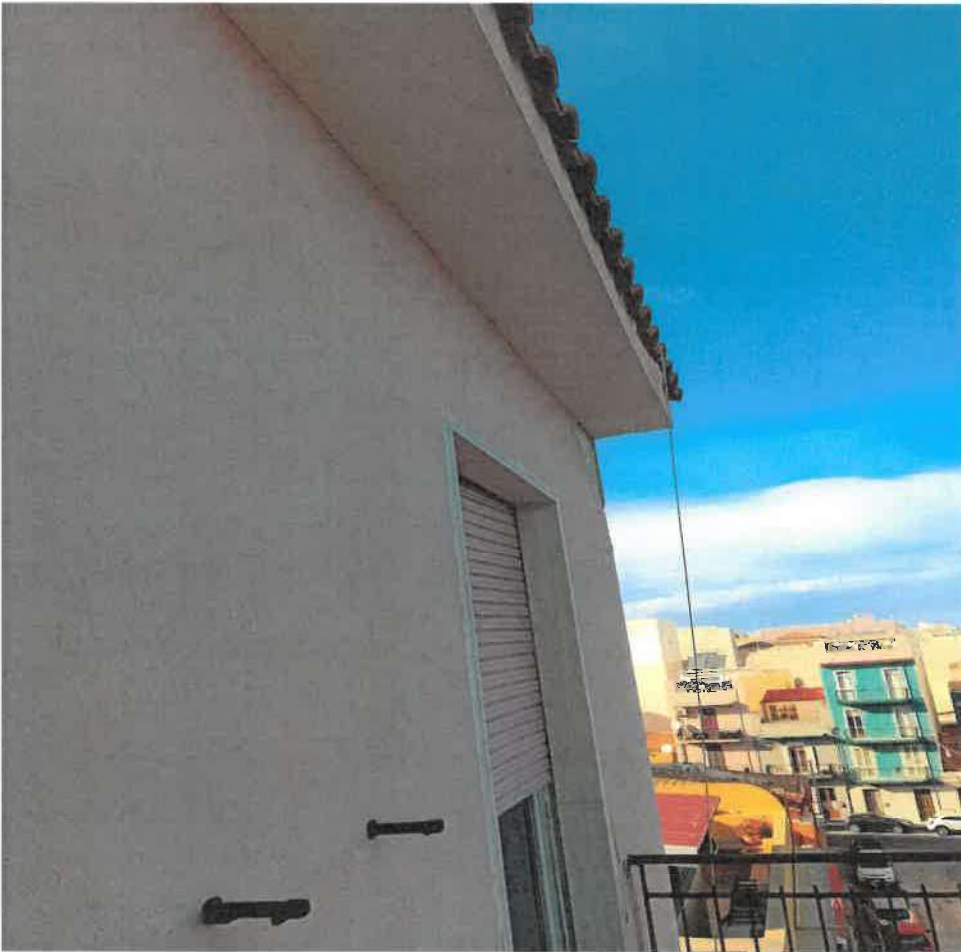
dettagli dal balcone del soggiorno (prospetto su Via Cordai)
